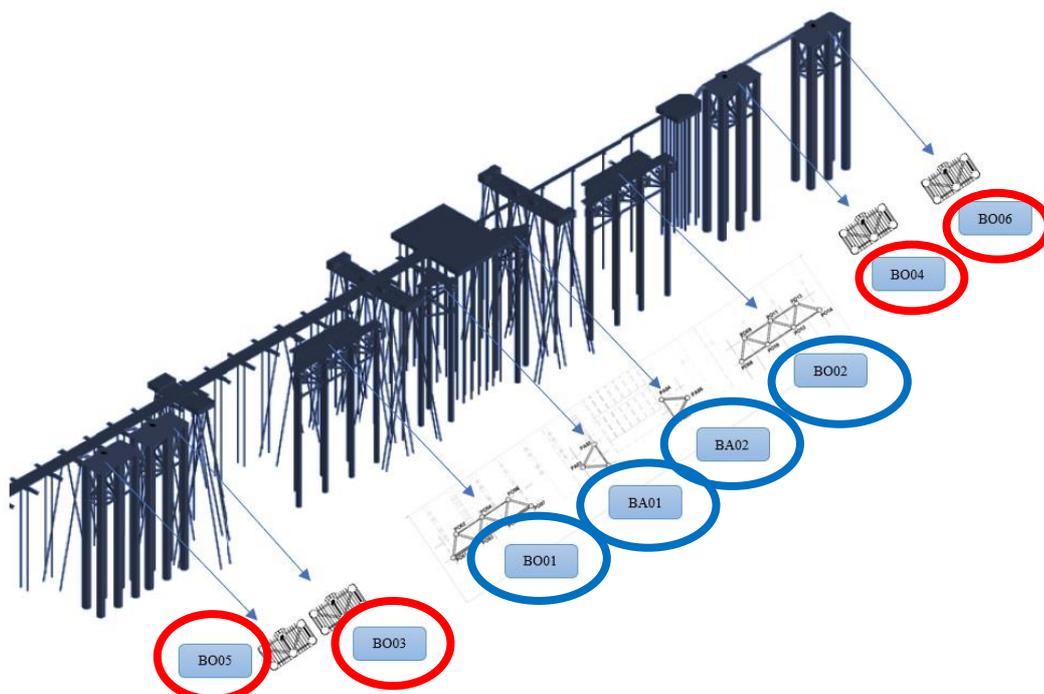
Configurazione futura del pontile: nel cerchio blu le briccole di accosto già autorizzate nell'ambito del progetto denominato "Vessel Reloading Panigaglia" approvato con parere n. 571 del 10 ottobre 2022; nel cerchio rosso le briccole oggetto del presente progetto di ammodernamento e adeguamento dell'impianto GNL di Panigaglia
